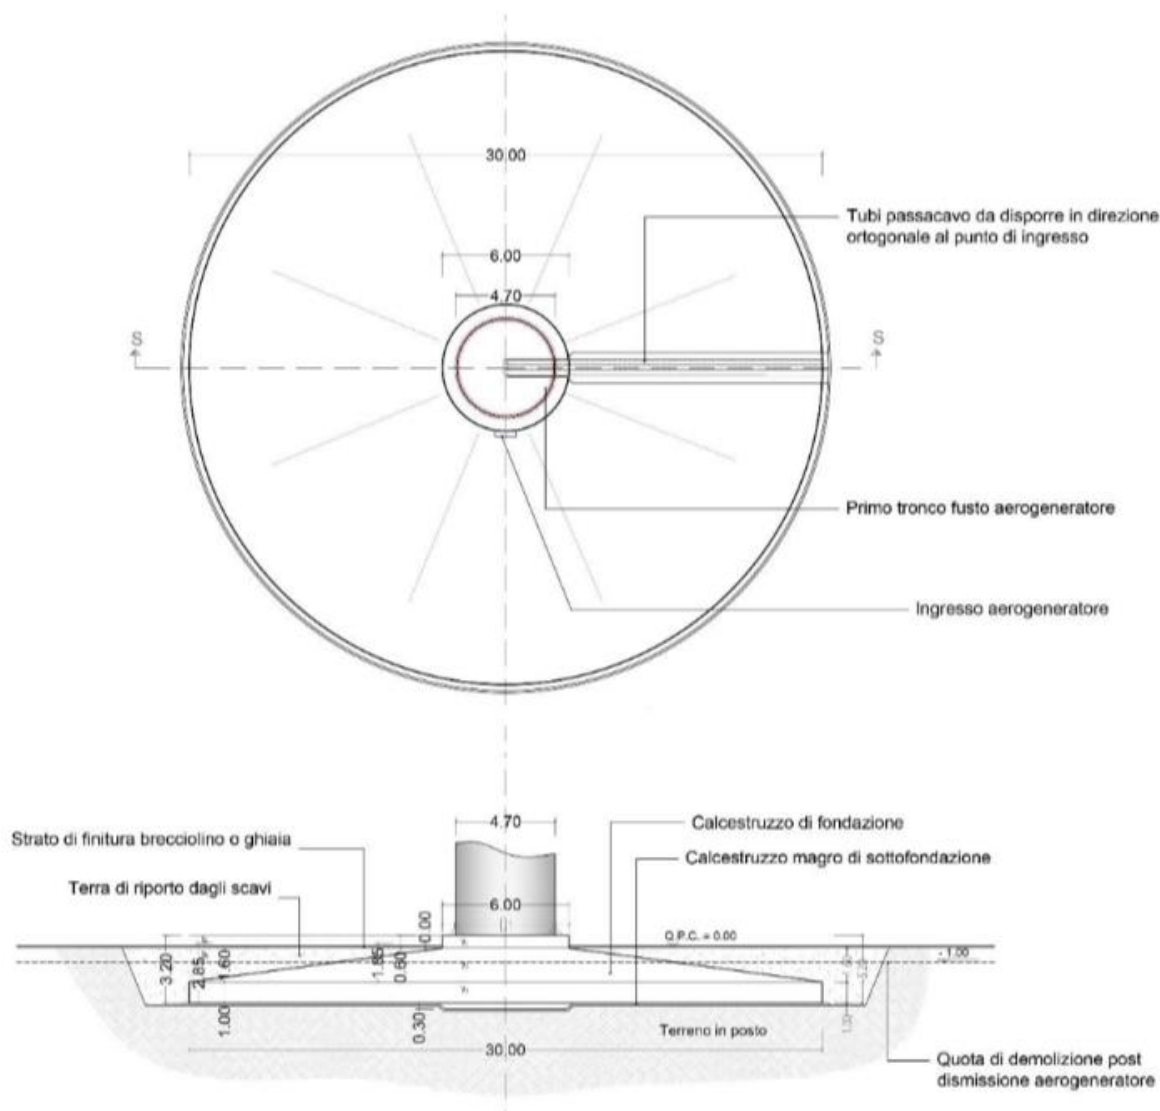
pianta e vista della fondazione tipo dell'aerogeneratore
